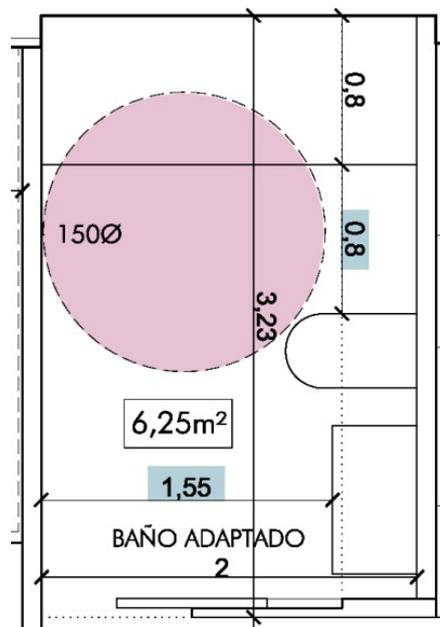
Plano figuras mínimas inscribibles baño adaptado. Fuente propia.
